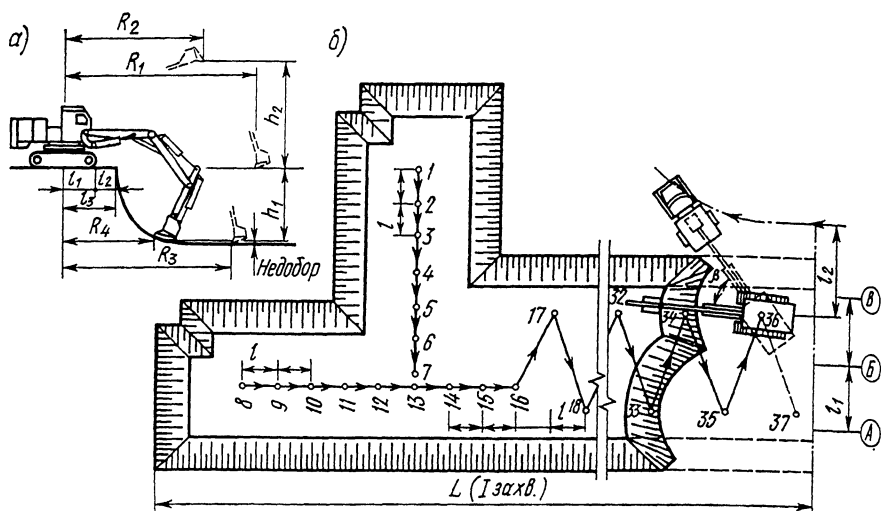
Разработка грунта экскаватором обратной лопата в котловане подземного пешеходного перехода:
